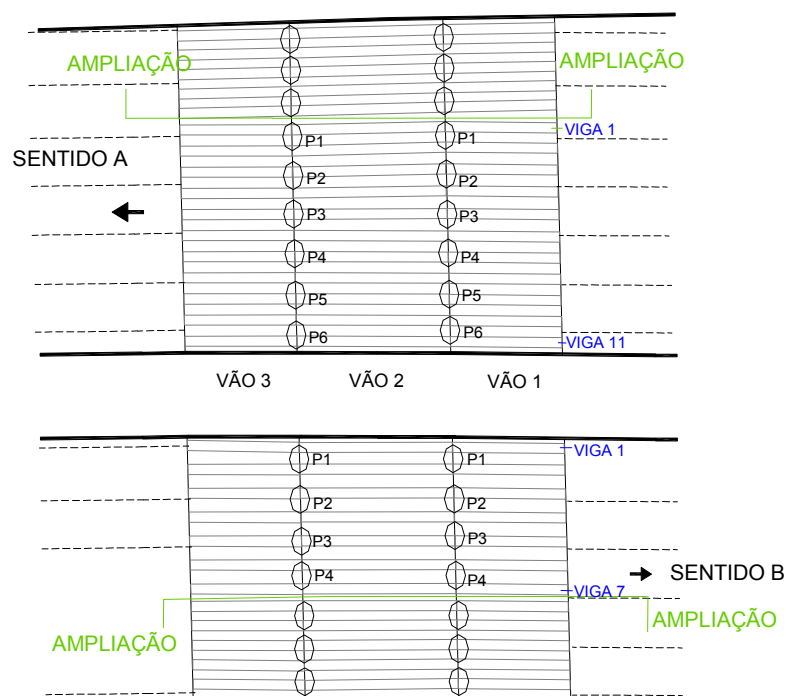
Vista em planta das passagens inferiores situadas no p.k. 14 + 590
